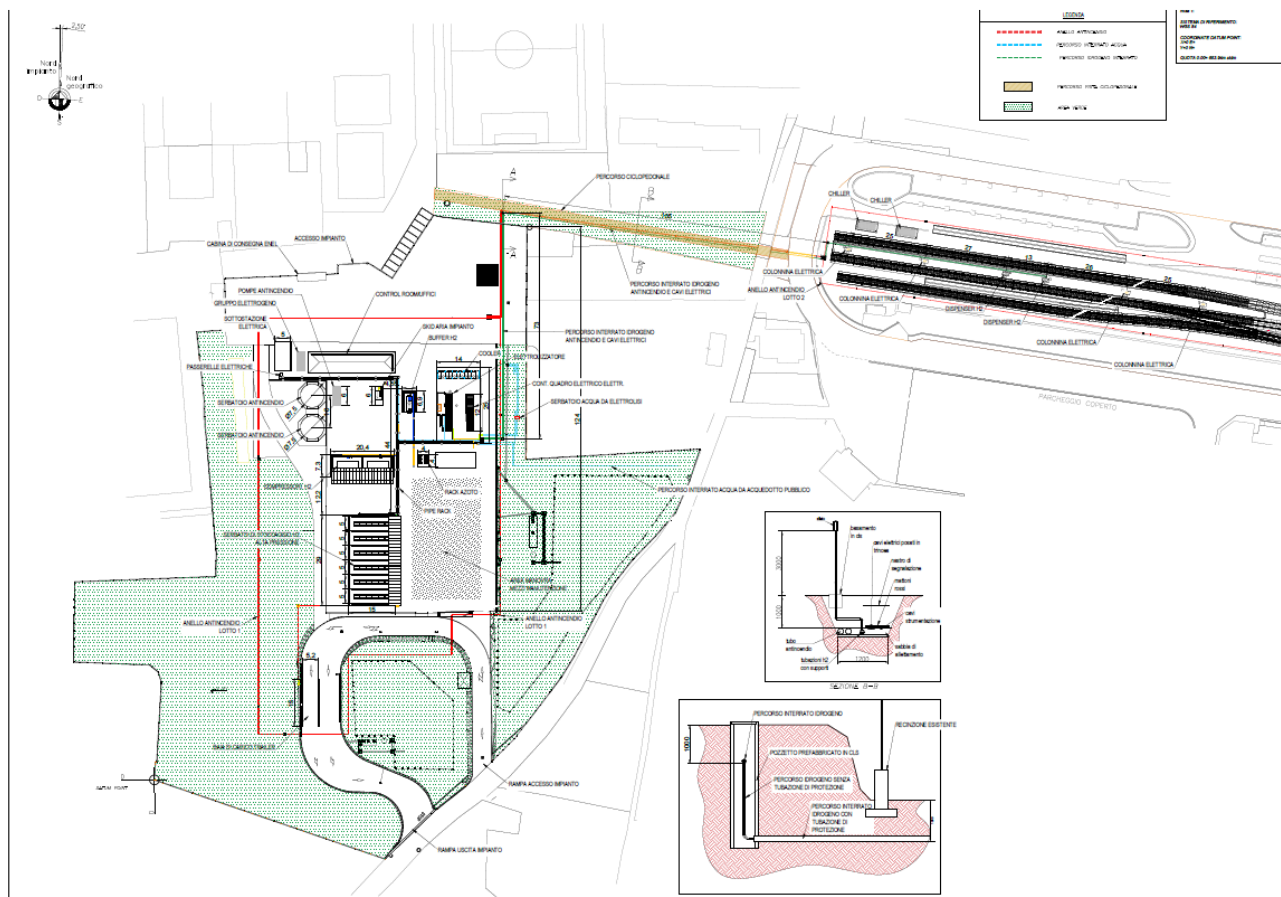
Planimetria generale – Stato di Progetto (B35-D-d-010-VV)
